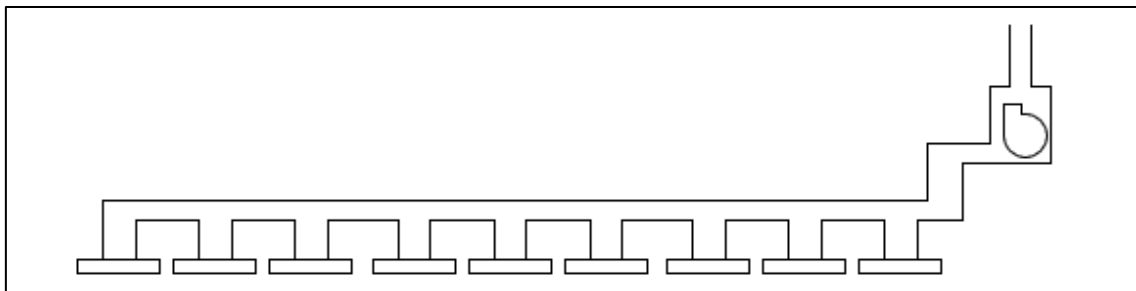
Sistema de extracción del laboratorio de impresión 3D. Fuente: Elaboración propia.
